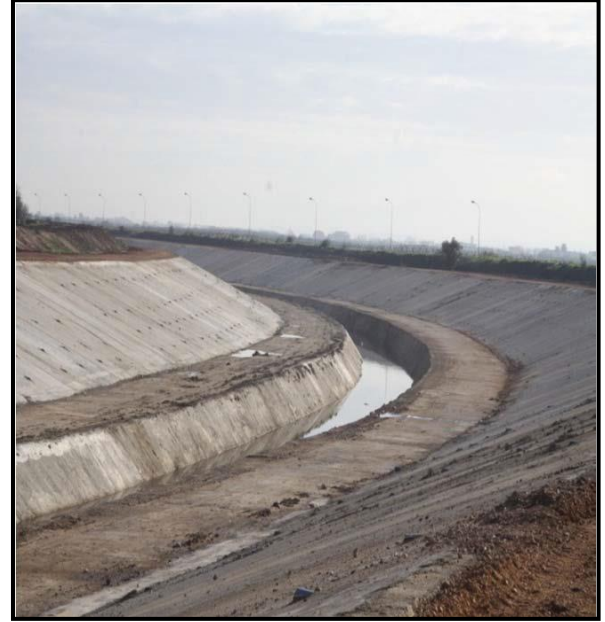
Intervention sur Oued M'zab (Source : MRE, 2018)
